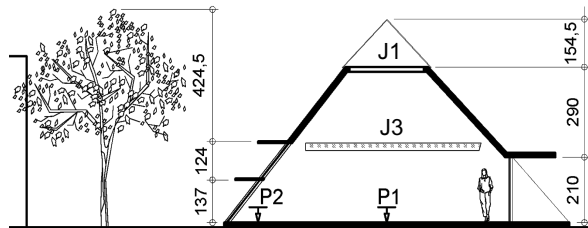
Corte Longitudinal da edificação proposta. Fonte: Elaborado pelos autores.
